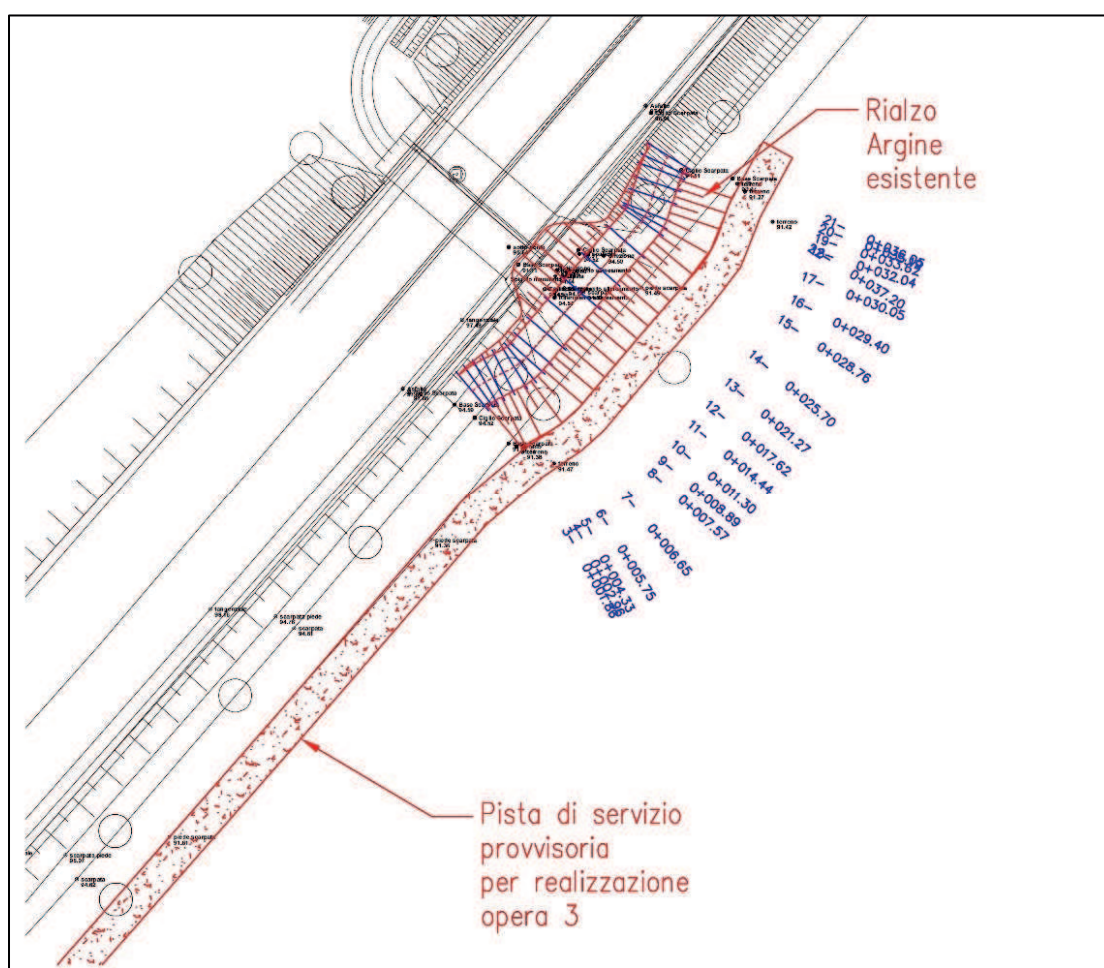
Arginatura chiusura terzo fornice – Planimetria
